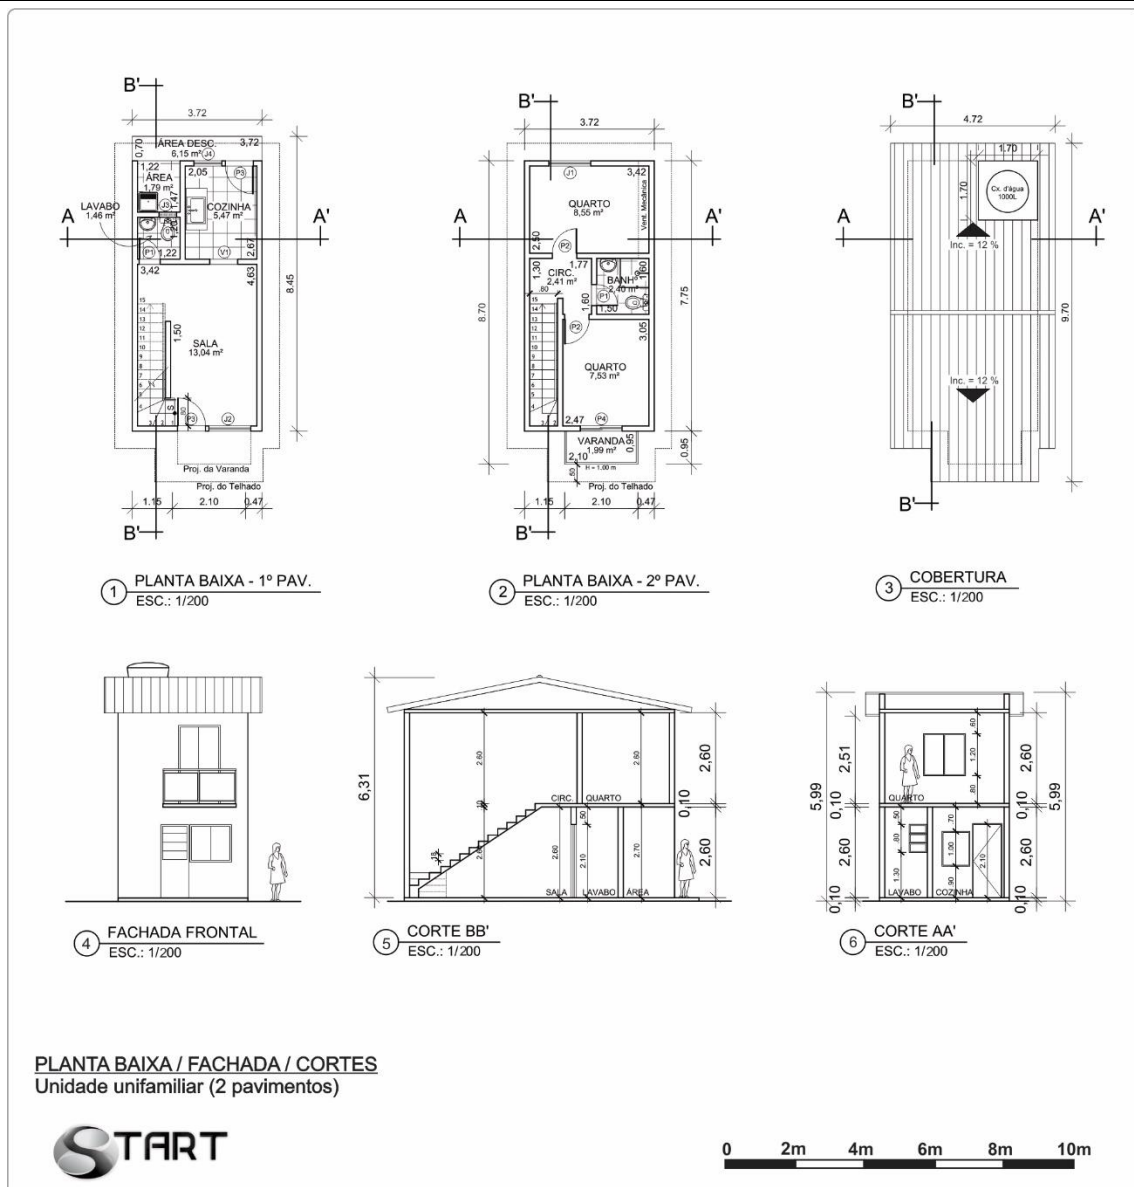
Planta baixa, fachada e cortes da unidade unifamiliar de 2 pavimentos
